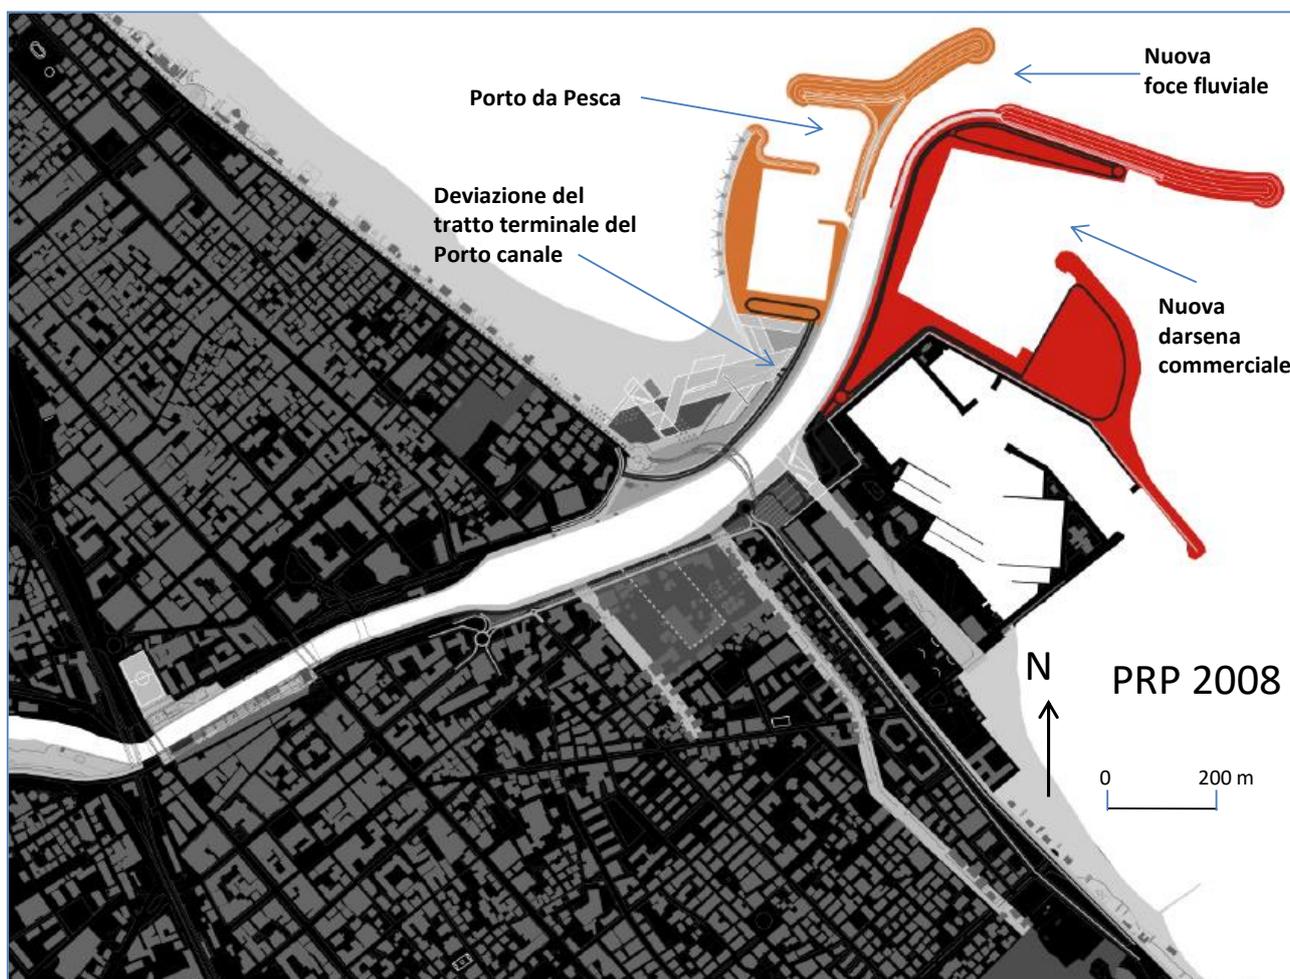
Nuovo assetto planimetrico e destinazioni d'uso previsti dal PRP 2008.
